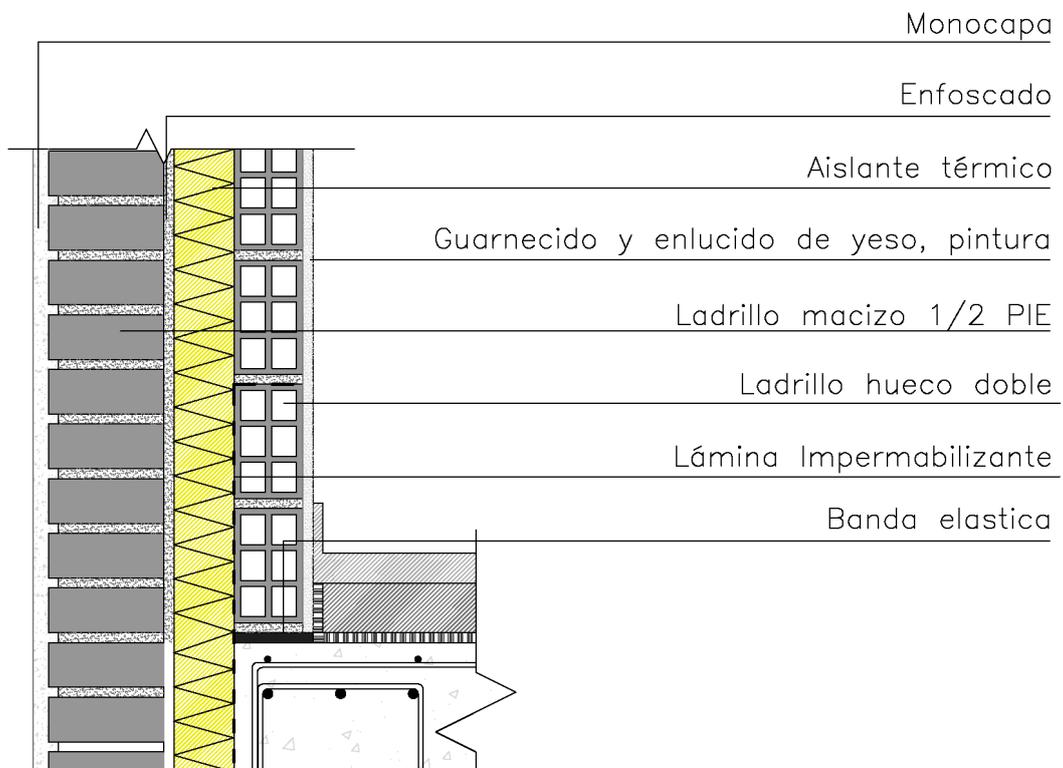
Esquema constructivo de la fachada. Elaboración propia.
